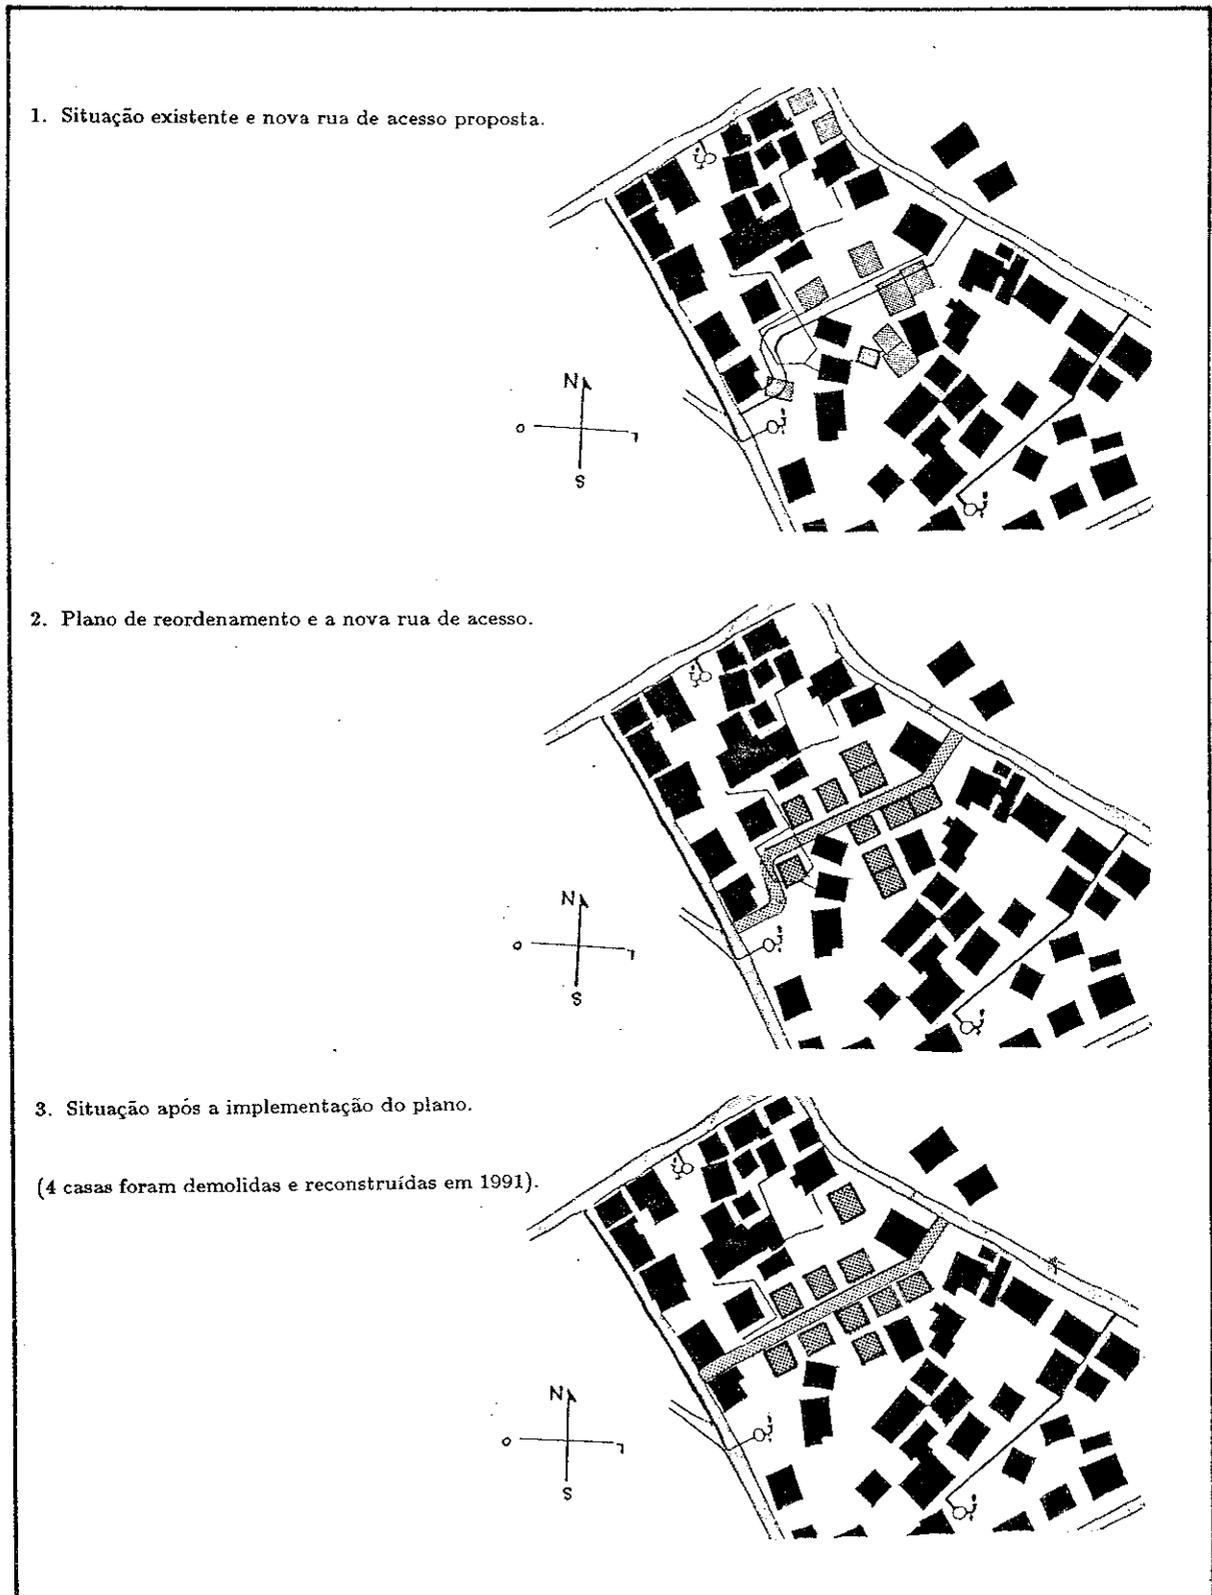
Planta baixa do Setor de Mindará, objeto de intervenção do PMBB
